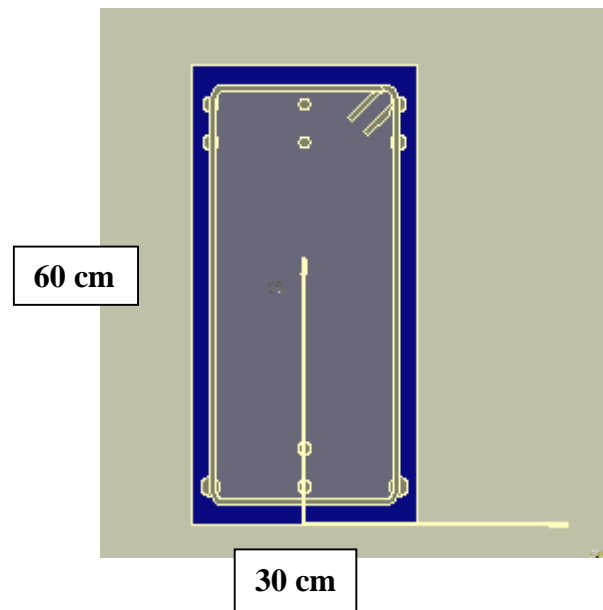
La section courante de la poutre dans les bâtiments testés.[9]
